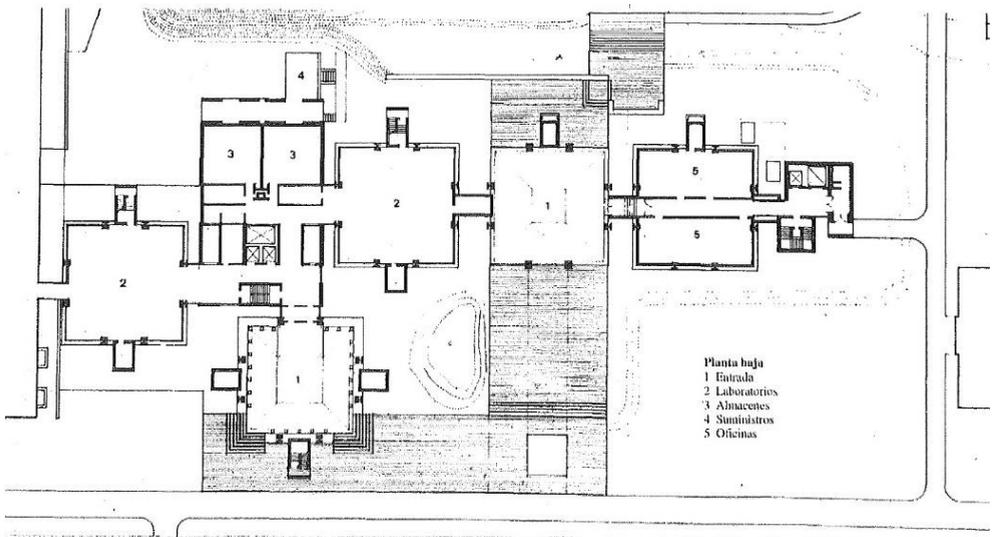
Planta baja de los laboratorios Richards en Filadelfia. fuente: Capitel, «Arquitectura europea y americana después de las vanguardias». Summa Artis, 484.
